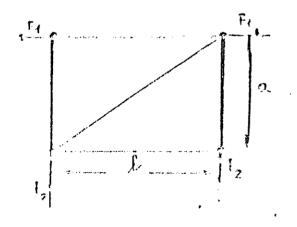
Prova di rigidezza di schema funzionale in pianta (trazione)
